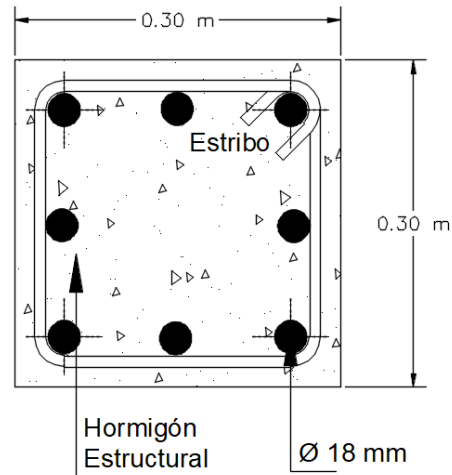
Esquema de columna a diseñar 0.30 x 0.30 m. Fuente: Autoría Propia
